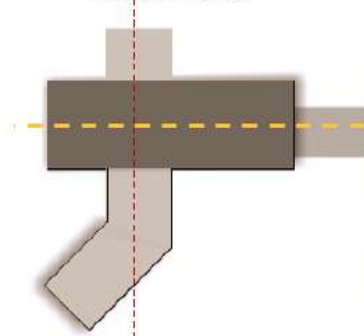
Planta esquemática con la volumetría de la propuesta arquitectónica. Elaboración propia
